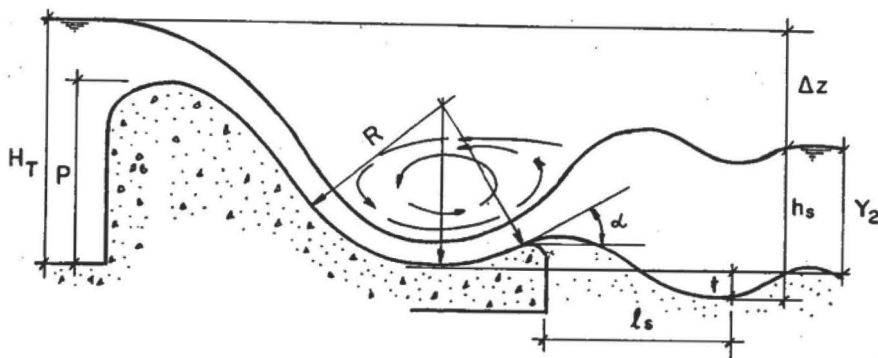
Erosão a jusante de estruturas tipo concha submersa ("roller bucket")
